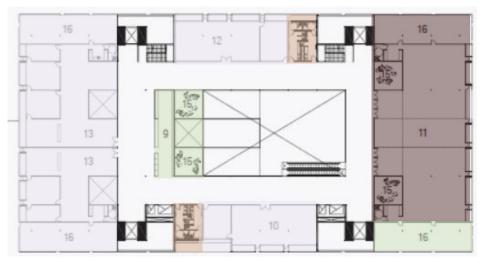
Planta primer nivel del centro cívico Rafaela Fuente: archdaily
